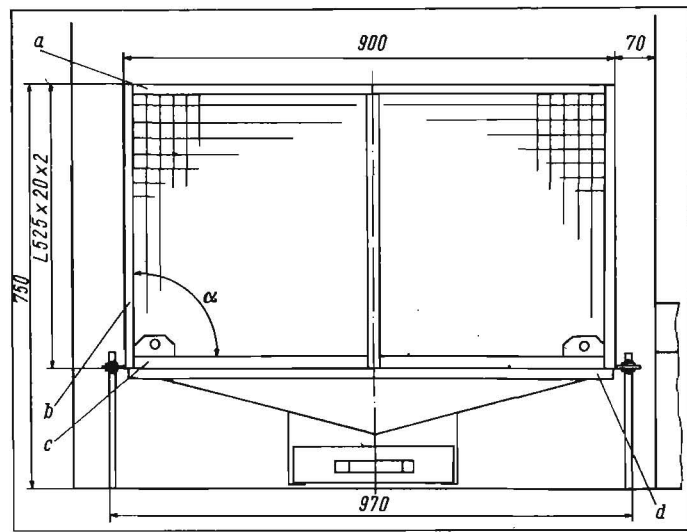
Dimensionierung und Gestaltung der Standraumseitenwände; a Waagrechtstrebe, b Senkrechtstrebe, c Rahmenstrebe, d Rahmenstrebe, seitlich
